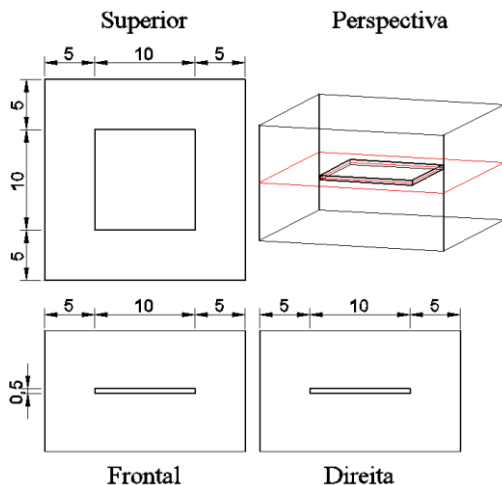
Pilar concretado com placa de EPS (cm)
